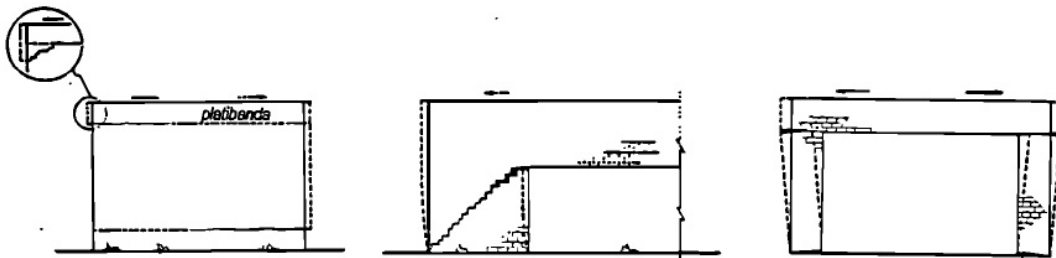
Configurações típicas da fissuração de paredes devida aos movimentos de origem térmica das coberturas e das estruturas reticuladas [5]
